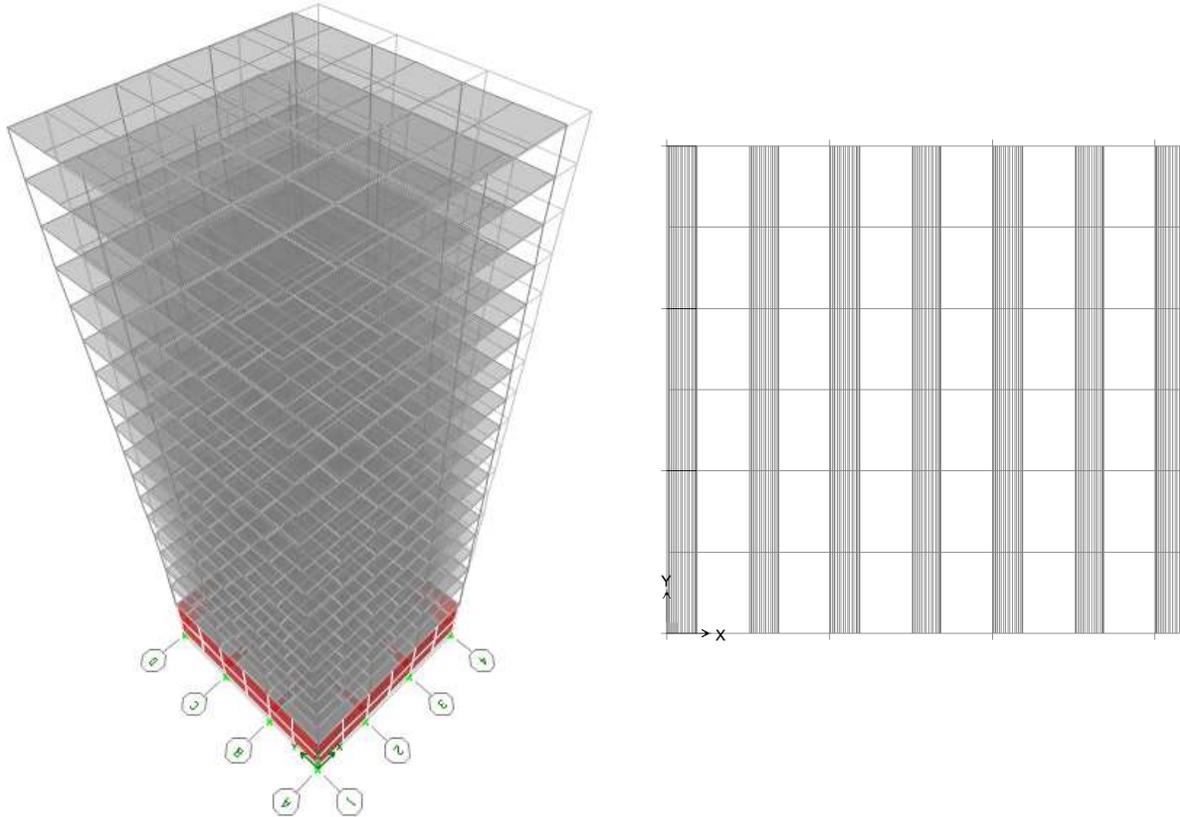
Vista en elevación y planta de la deformada del primer modo de vibrar del edificio de 17 niveles
